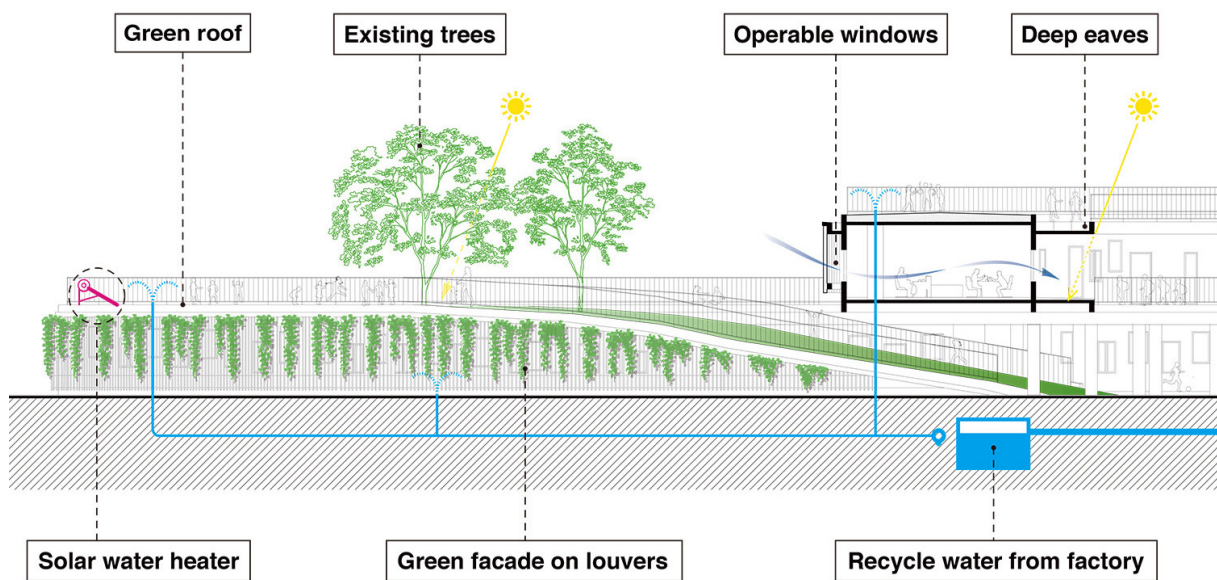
B Sección y estrategias de diseño sustentable. Fuente: Intervención propia sobre Planta extraída de Arch Daily
